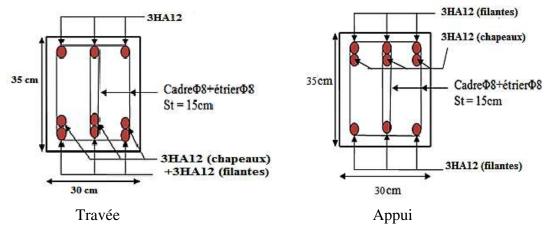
Schéma de ferraillage des poutres secondaires de terrasse.
